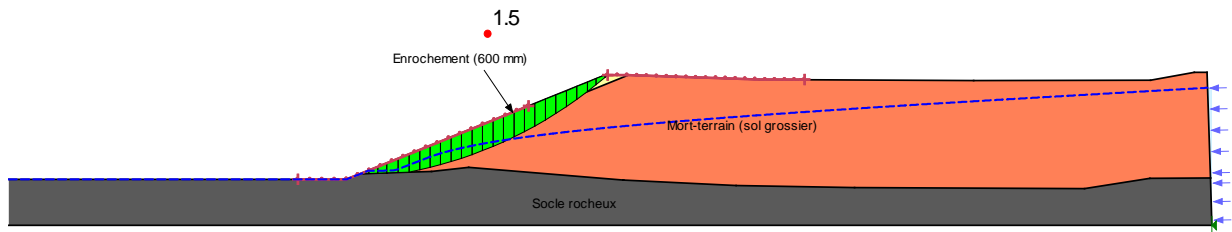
Stabilité long terme avec une couche d’enrochement de 600 mm, excavation dans des sols grossiers
